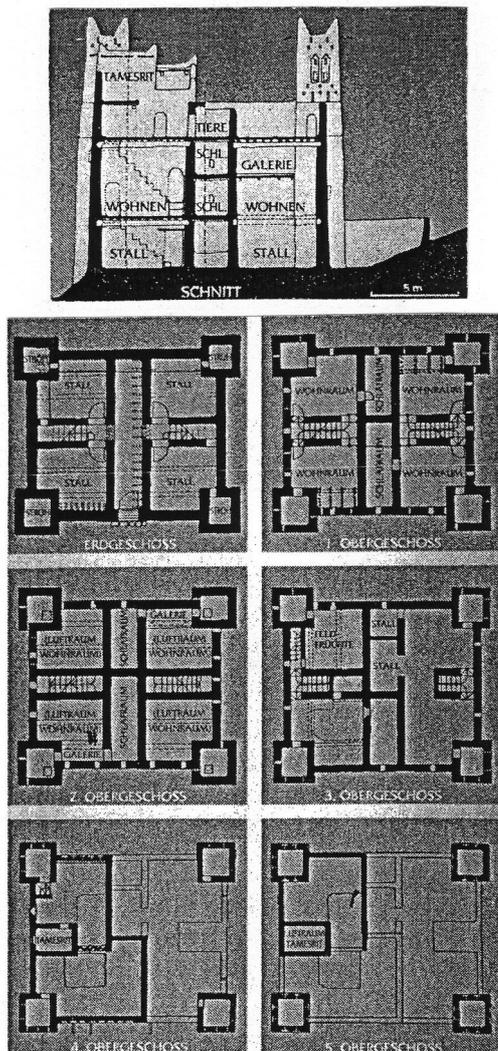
Schnitt durch eine *tighremt* (Gangtyp) sowie Grundrisse der verschiedenen Stockwerke
